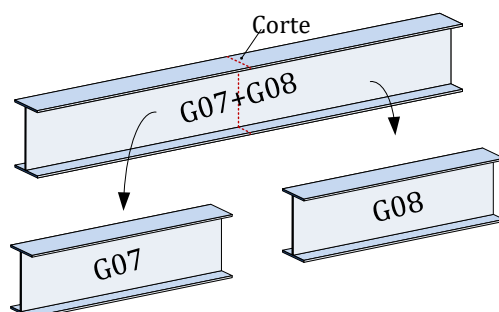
Corte da viga original em duas vigas de igual comprimento
